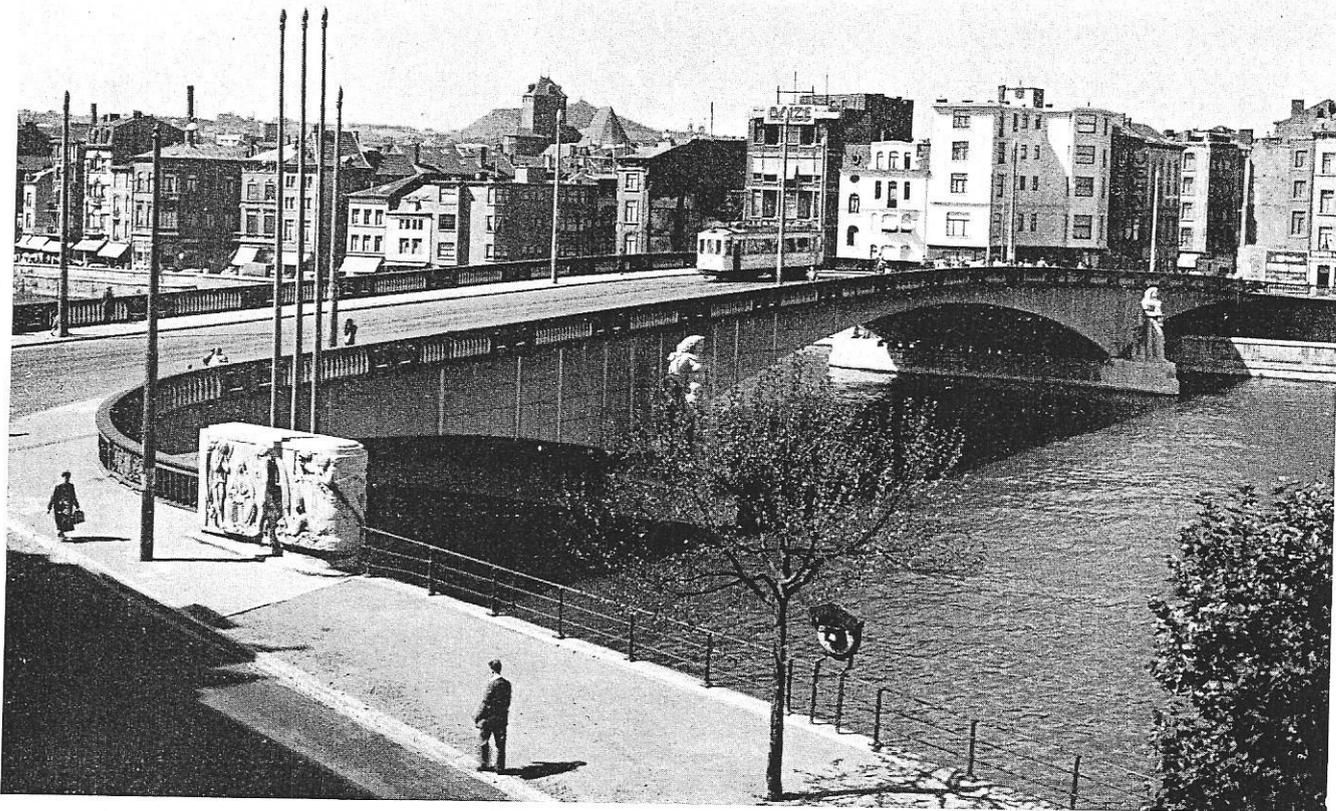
VUE D'ENSEMBLE DE L'OUVRAGE, PRISE DE L'AVAL.
